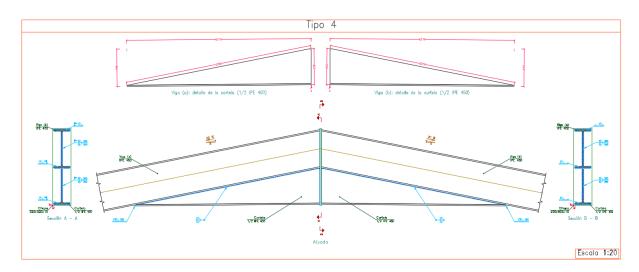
Detalle de unión soldada jácena-jácena en cumbrera
